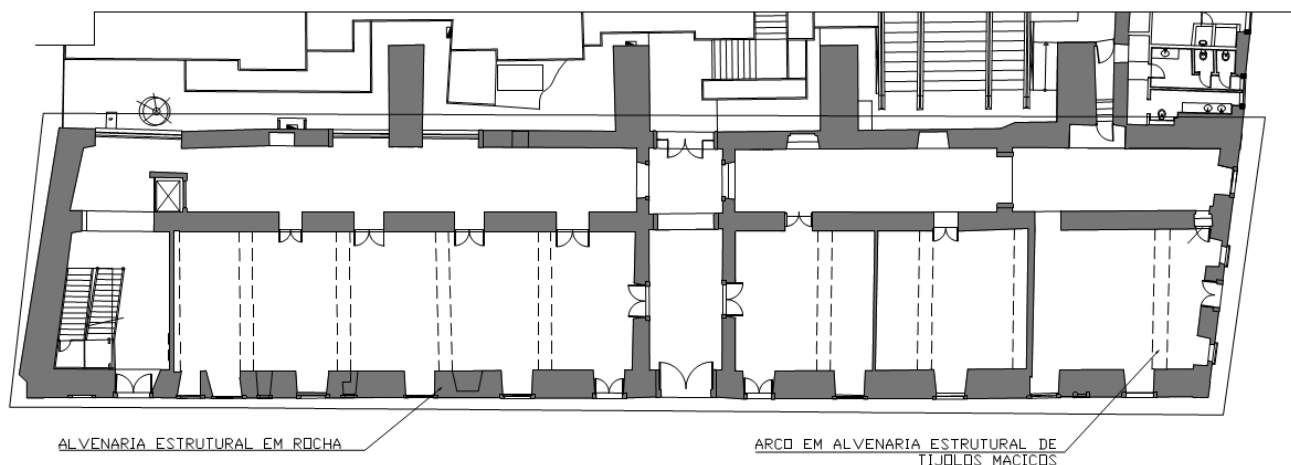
Planta baixa do Pavimento Térreo o Bloco 01
